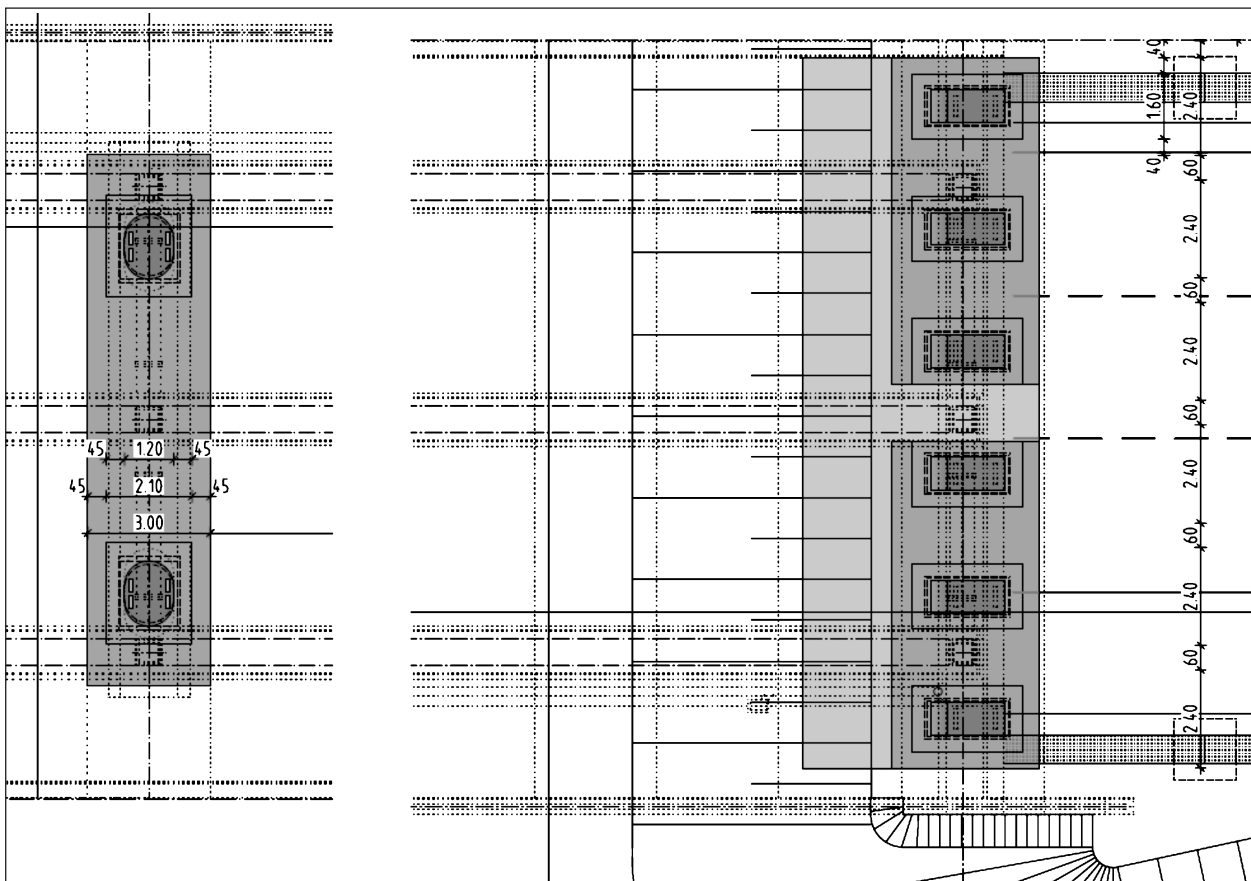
Grundriss der Fundamente Pfeiler und Widerlager
